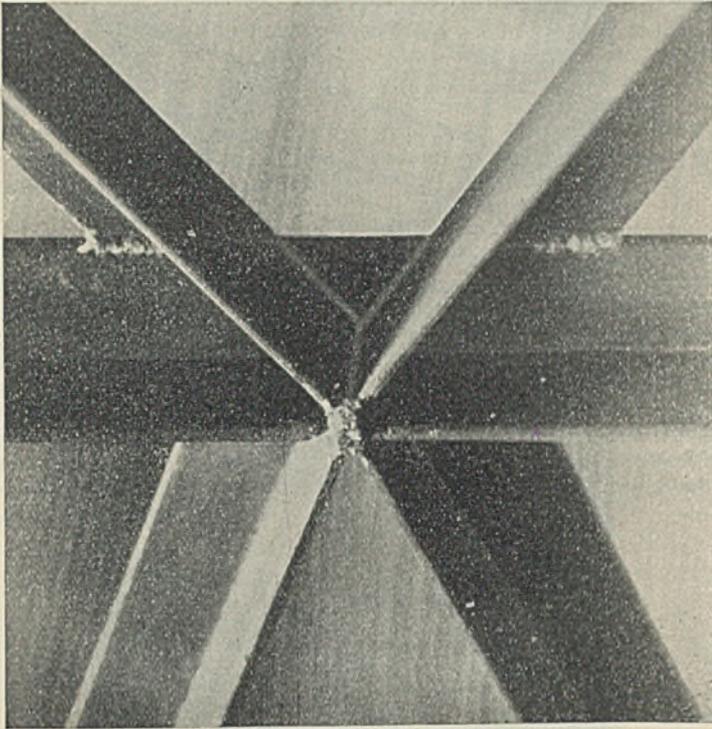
Mittelknoten des 6,20 m hohen geschweißten Gerüstbockes einer Rohrbrücke.
